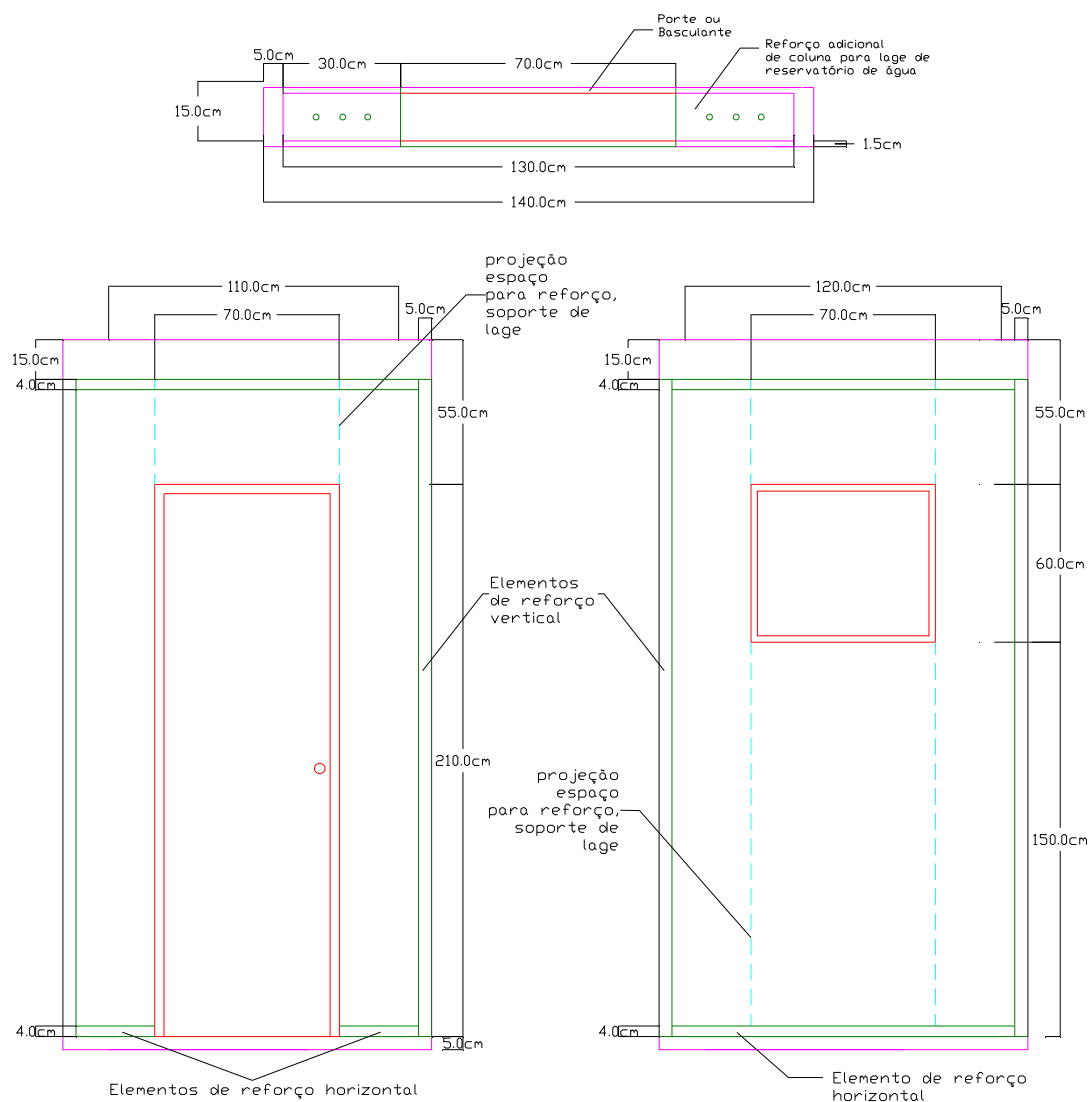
Corte transversal de um painel com adaptação para porta e basculante do banheiro (acima) e vistas frontais dos respectivos painéis correspondente à segunda alternativa do sistema construtivo.
